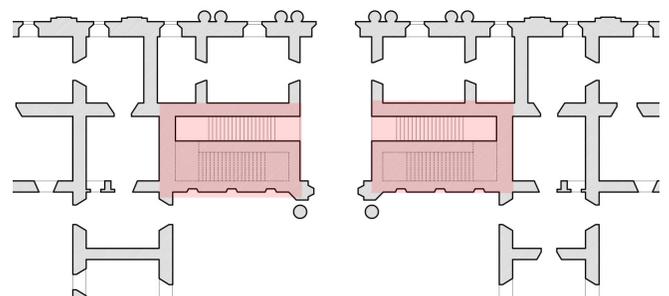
Detalle planta bóvedas configuración original. Elaboración propia
